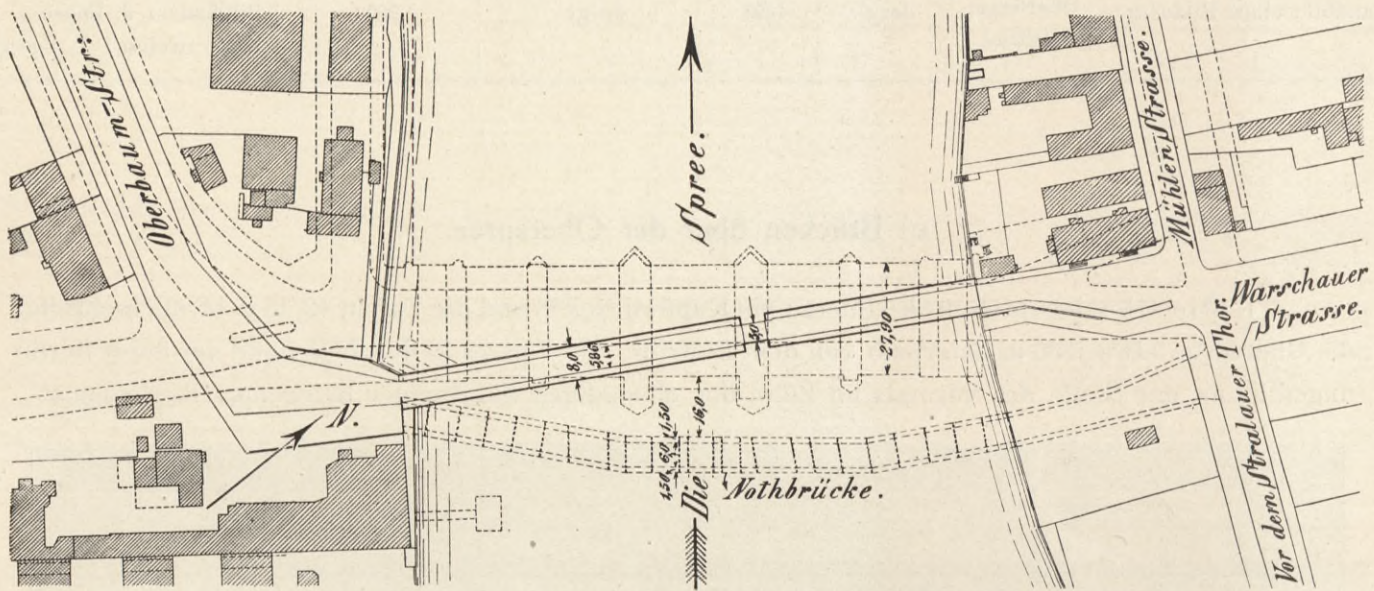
Lageplan der hölzernen Oberbaum-Brücke vor dem Umbaue.
